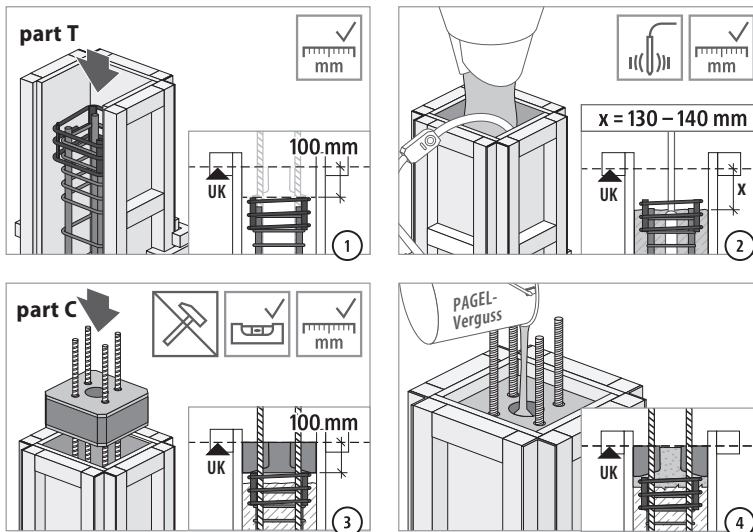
Einbau Sconnex® Typ P – wesentliche Schritte (Quelle: Einbauanleitung Schöck Bauteile)
